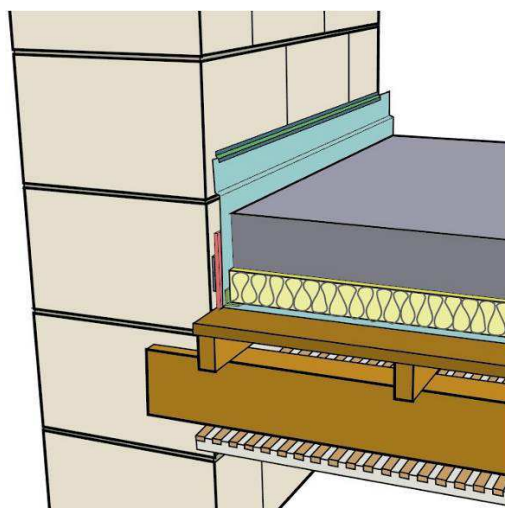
Désolidarisation périphérique entre chape ou dalle sur plancher et murs anciens
